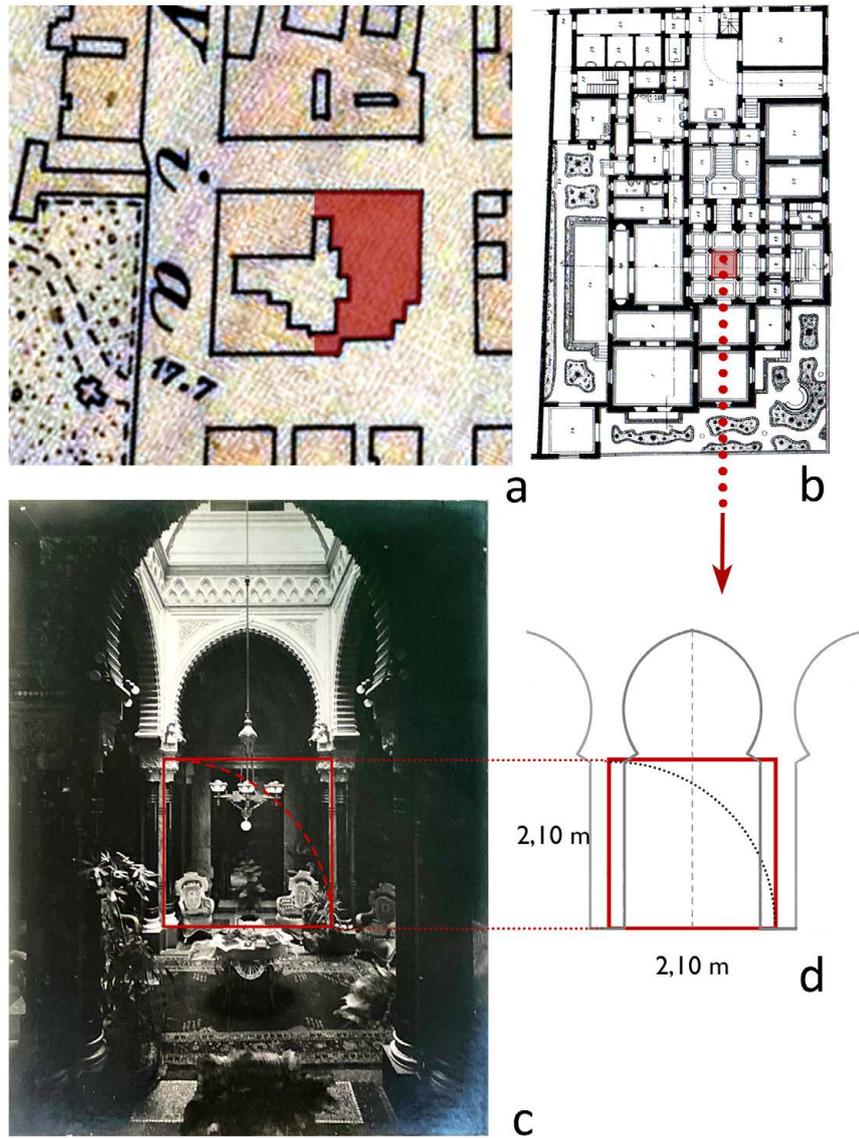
a) stralcio planimetrico con individuazione del lotto della villa Bonanno; b) riferimento planimetrico con evidenziato lo spazio interno della sala; c) schema del quadrato nella relazione tra larghezza e altezza della campata centrale; d) dimensionamento del quadrato e relazione con il profilo dell'arco. Elaborazioni degli autori.
